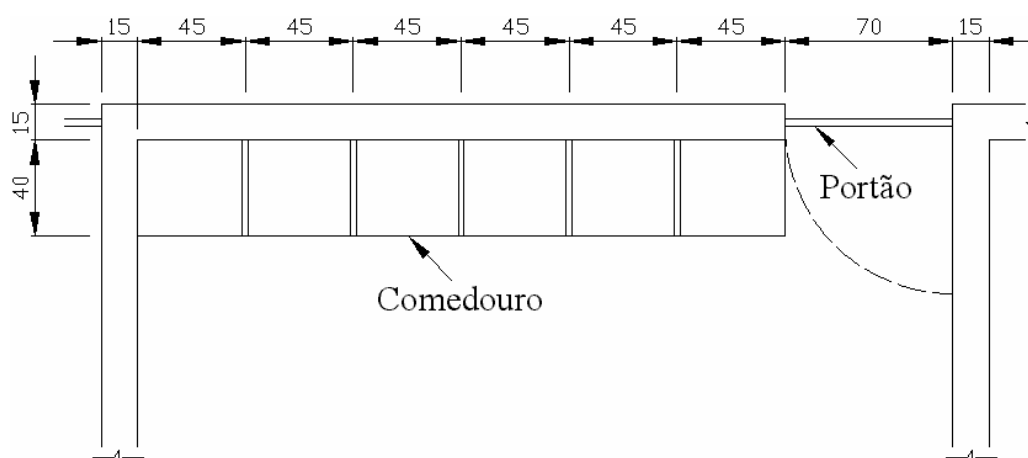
Planta baixa de uma baia para fêmeas em fase de pré-gestação ou gestação (sem escala, dimensões em cm) (adaptado de TEIXEIRA, 1997)
